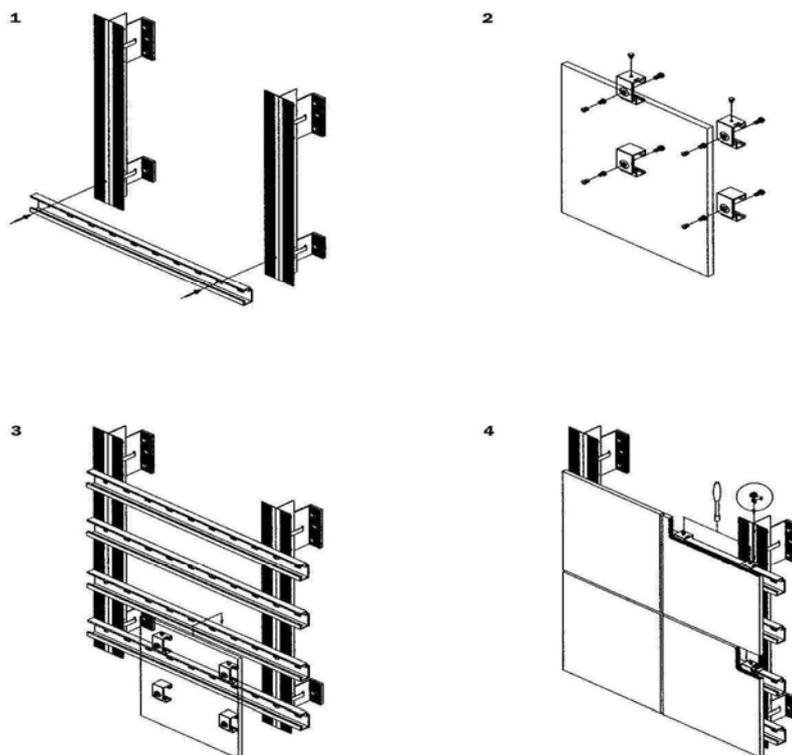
Esquema da sequência de montagem dos painéis de uma fachada ventilada.
